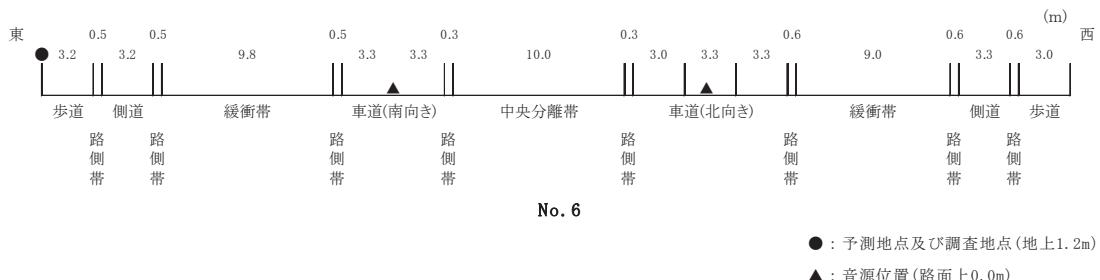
(2) 音源配置図（道路断面方向の配置イメージ:No. 6の例）
